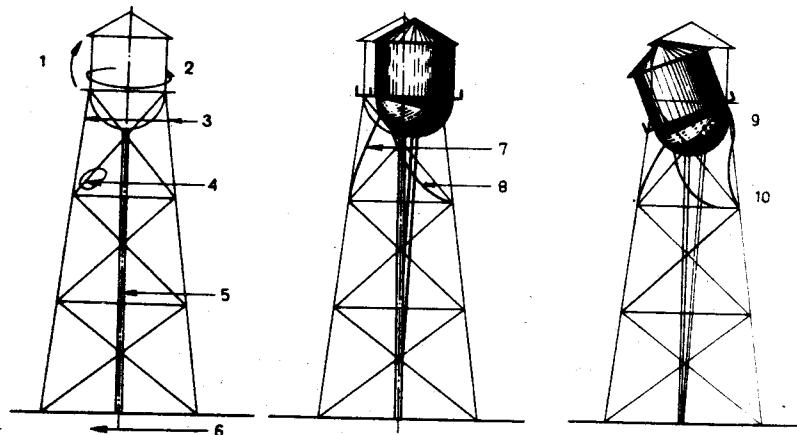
Последовательность разрушения приподнятого над уровнем грунта резервуара для воды, землетрясение Керн-Каунти, 1952, вертикальные разрезы
